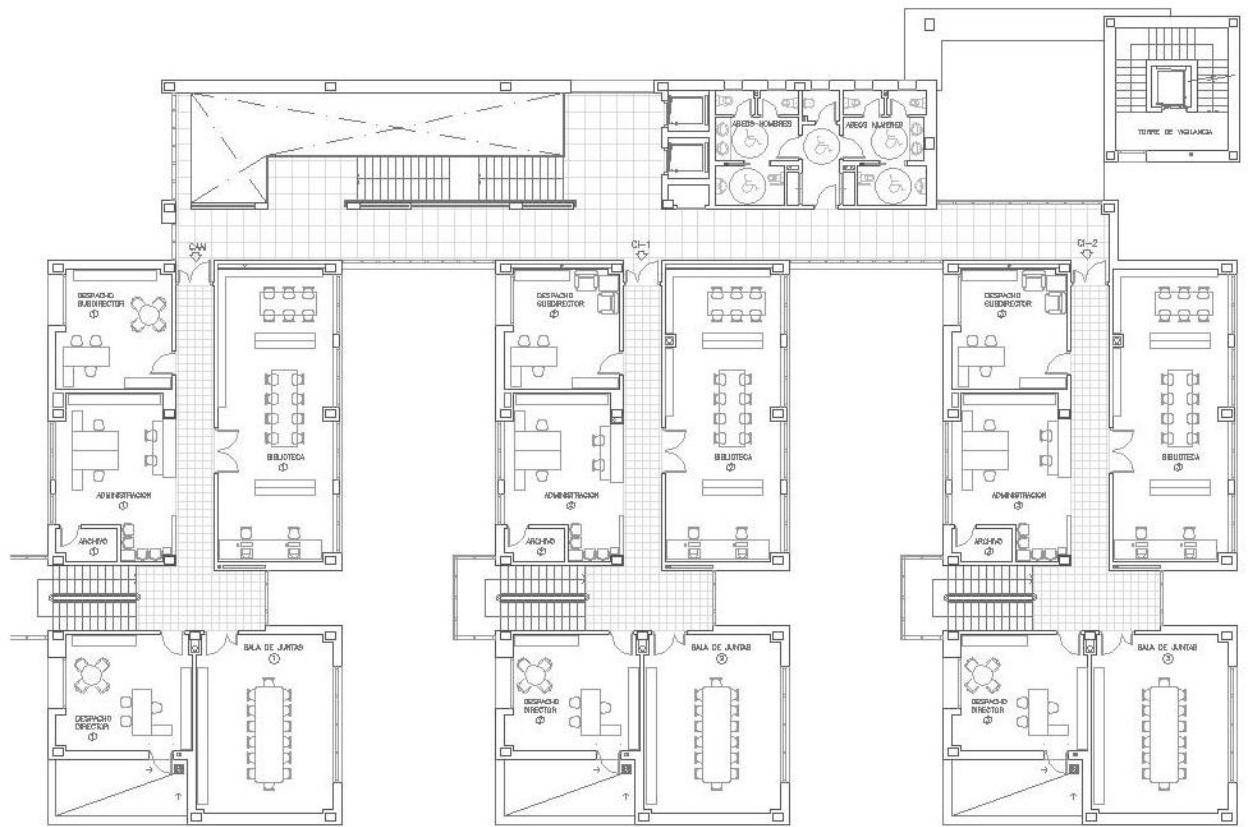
Planta segunda. Fuente: Proyecto técnico de ejecución.
